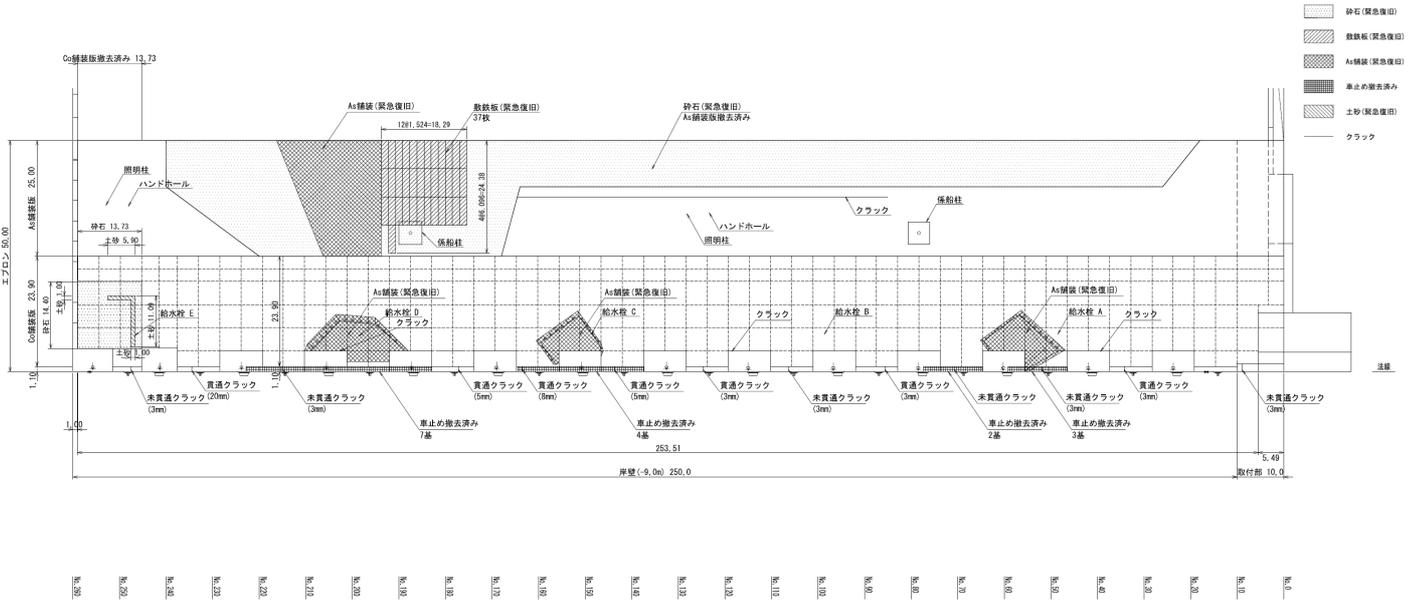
No.3 常陸那珂港区_中央ふ頭地区岸壁 (-9m)の平面図 (被災後)
